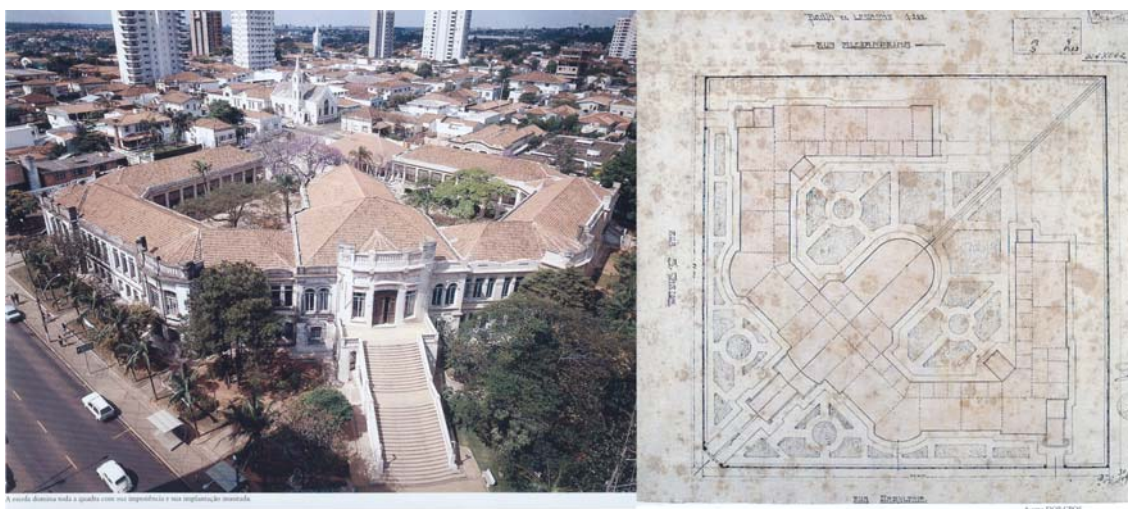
Foto do edifício e da planta original do projeto da Escola Estadual de Segundo Grau Instituto Álvaro Guião, construída em 1911. Fonte: Ferreira et al. (1998).
